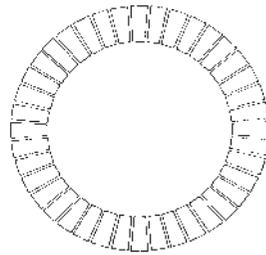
Arco pavimentado con adoquines cerámicos colocados a soga, o con pavimento a tizón..
